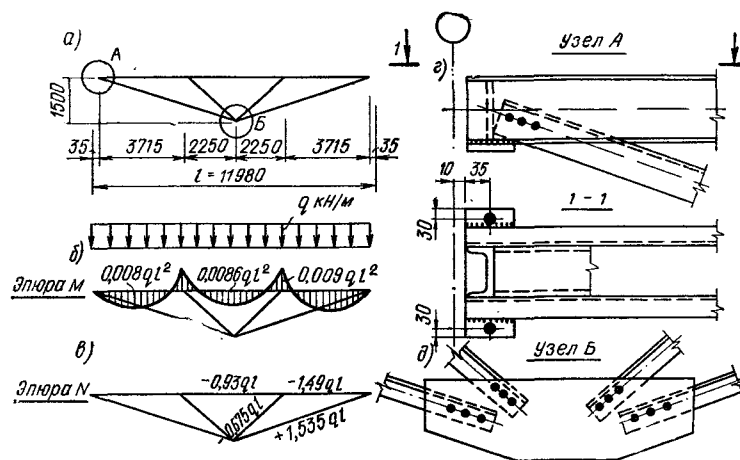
Типовой шпpеиrельный прогон из прокатных швеллеров на электрозаклепках (или на сварке) системы ЦНИИпроектстальконструкции
